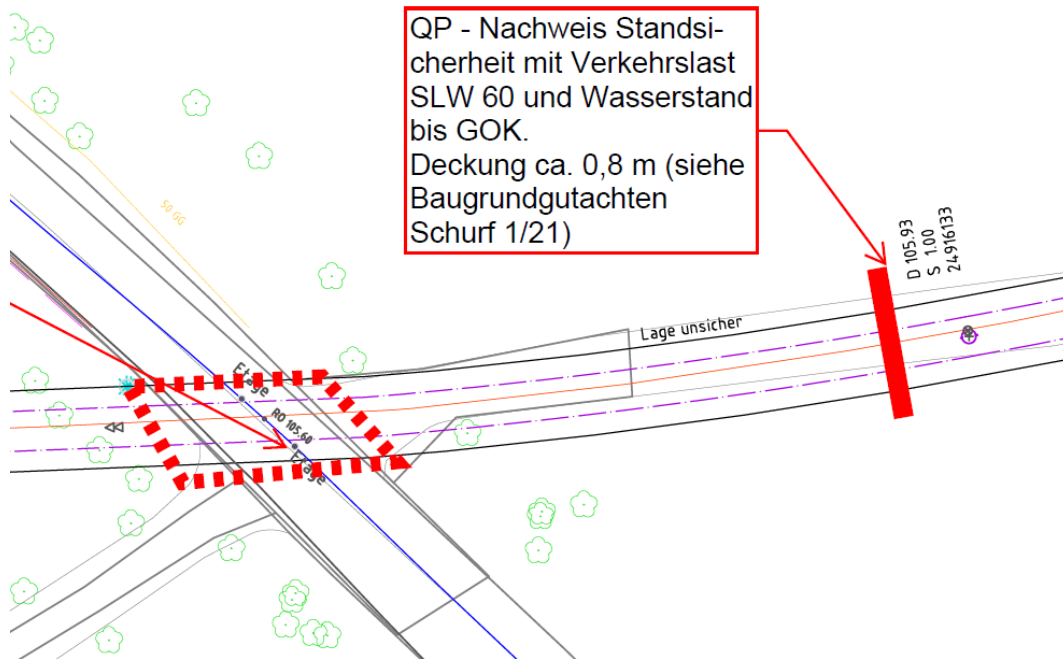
Bemessungsquerschnitt, Ausschnitt Lageplan, entnommen aus Unterlage [8]
